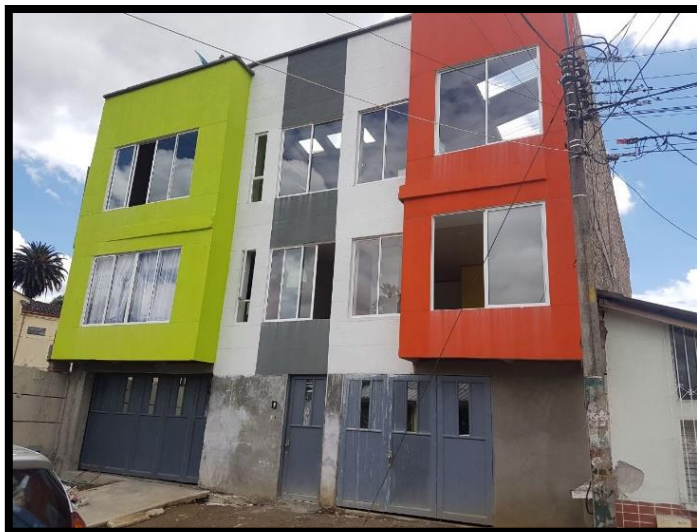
Construcción de edificación de cuatro niveles, con modificación de licencia, fuente propia.
